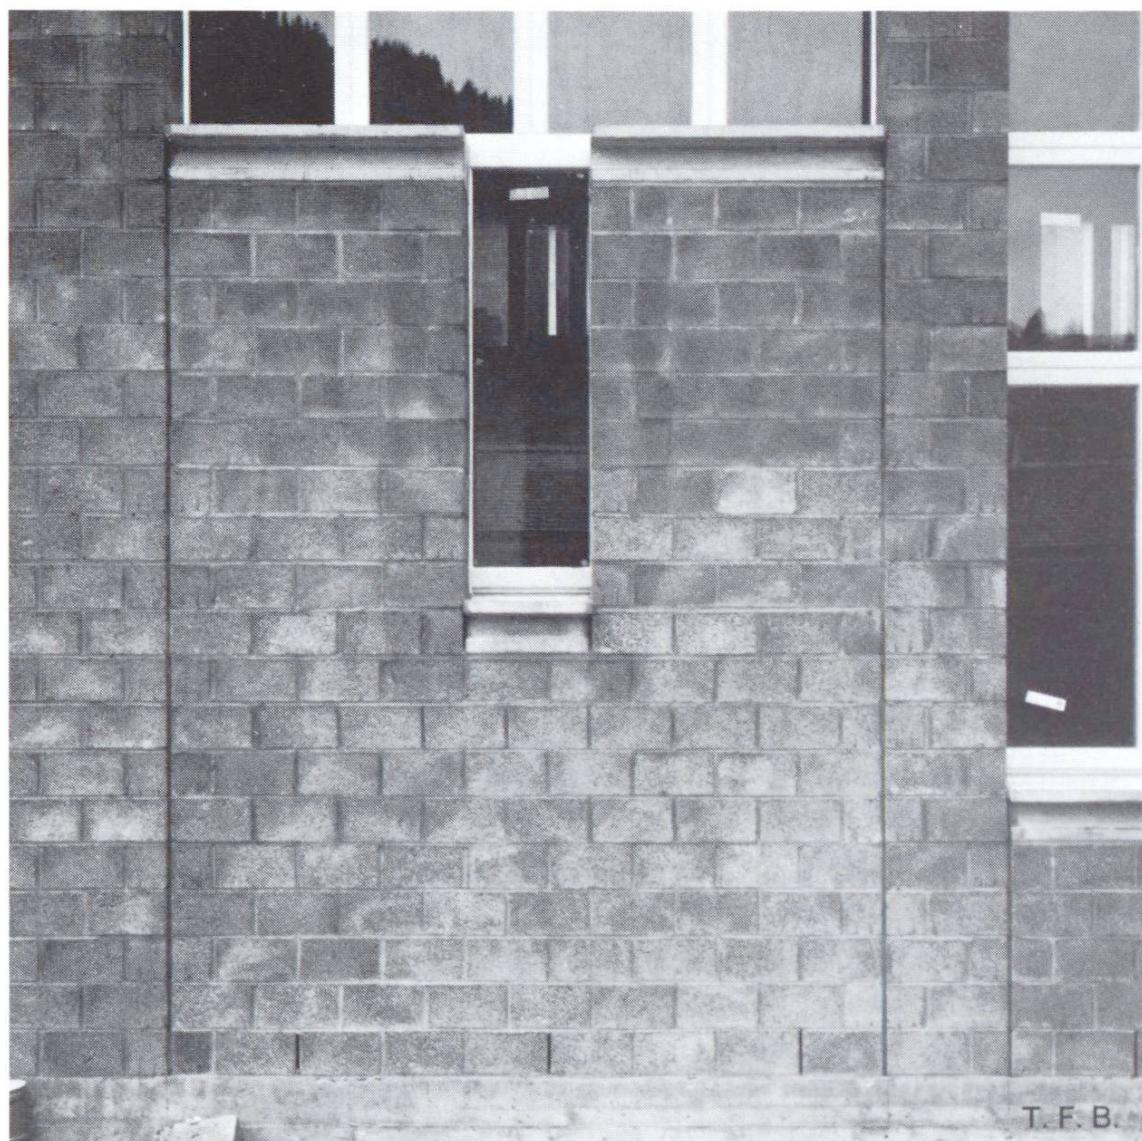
Sichtmauerwerk eines differenzierten Fassadenteils.
